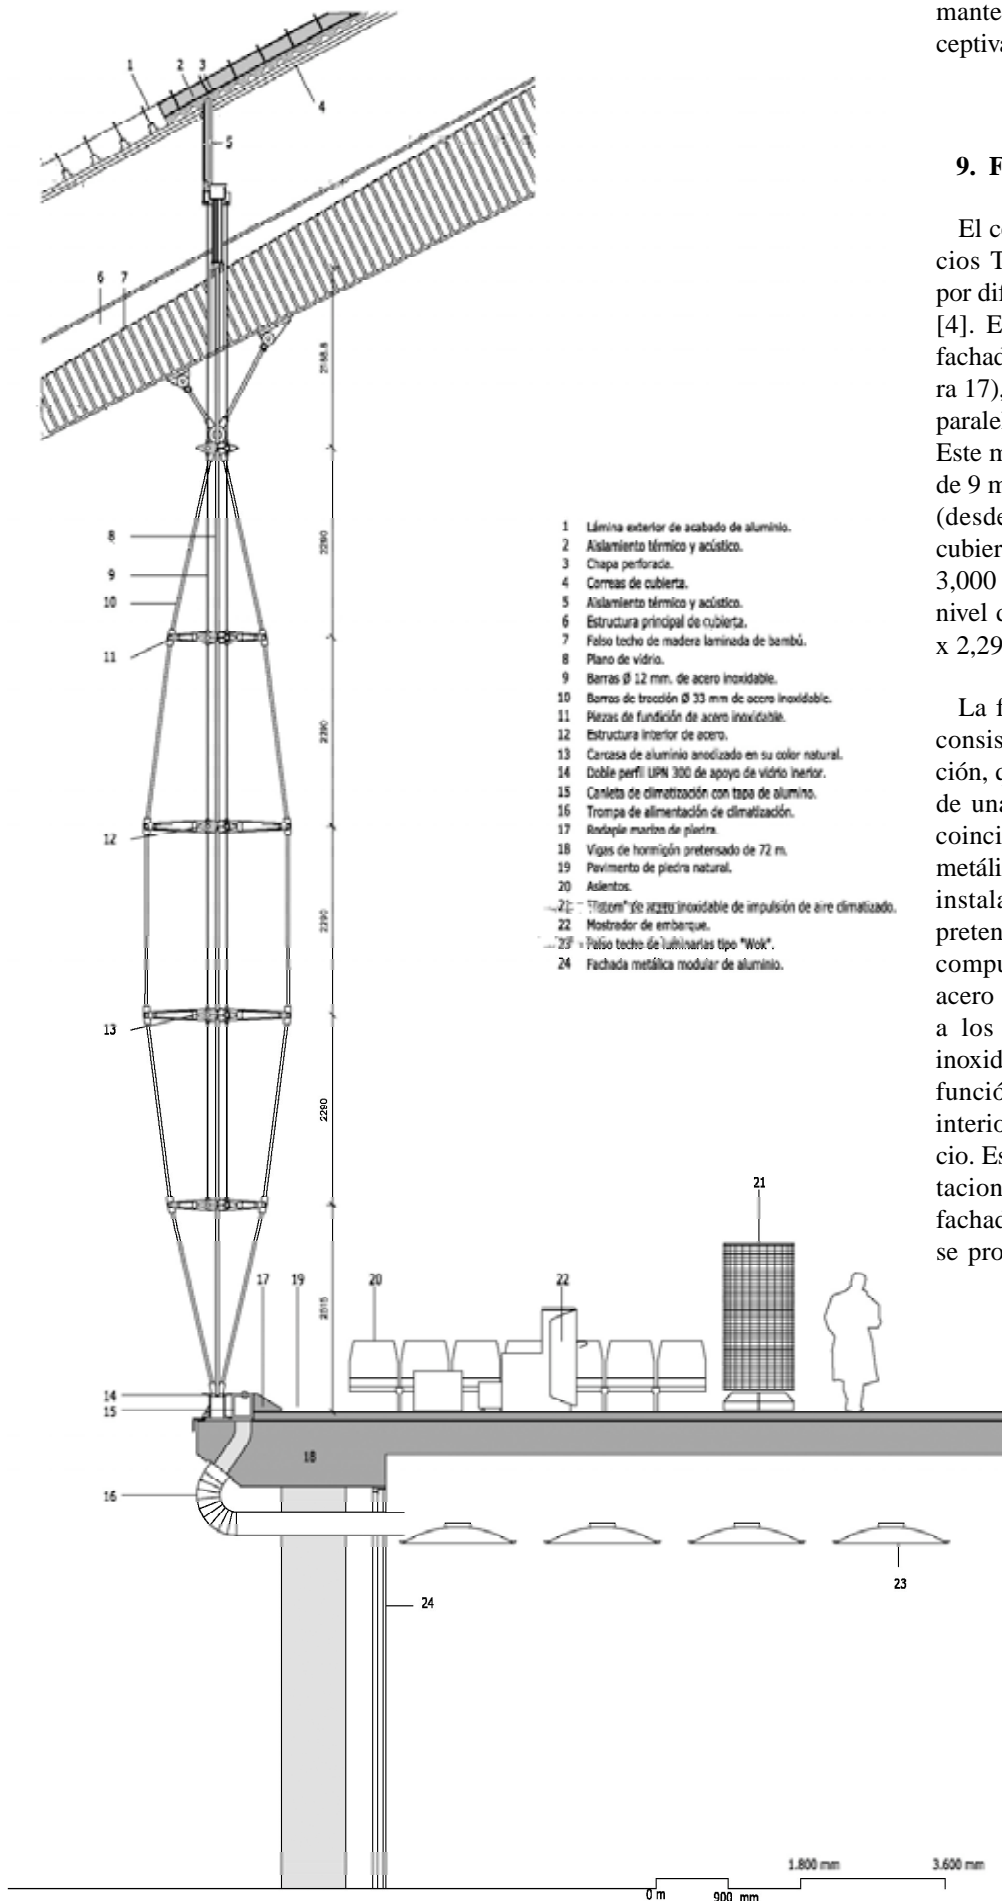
Sección constructiva de la fachada acristalada de los diques.
